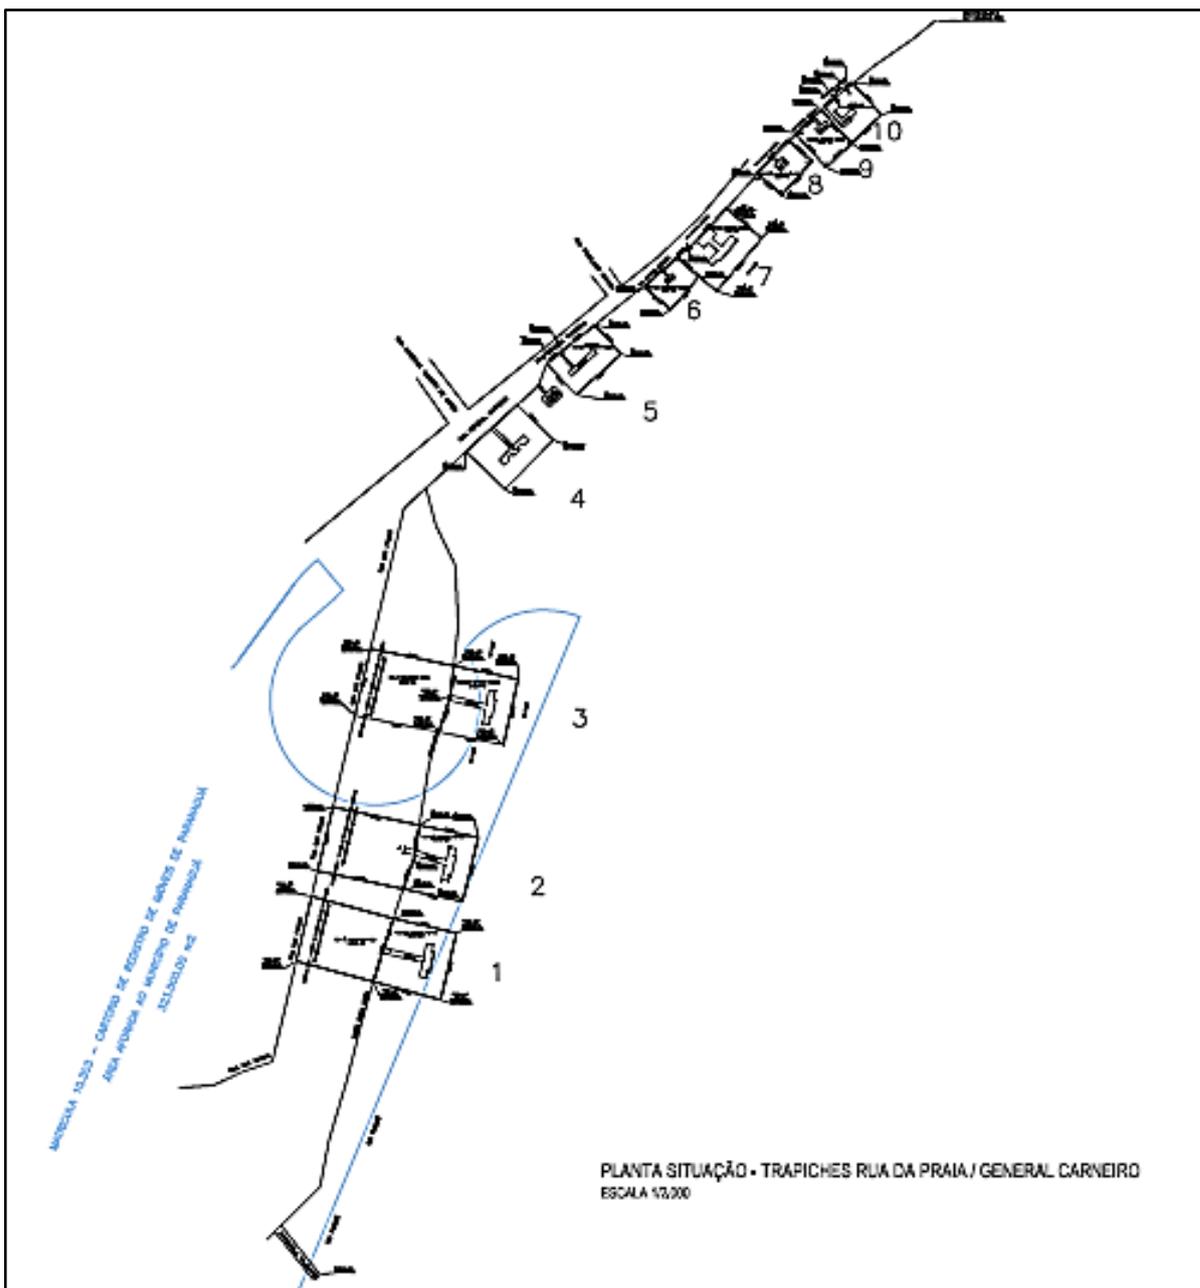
Planta de localização dos trapiches das Ruas da Praia e General Carneiro
